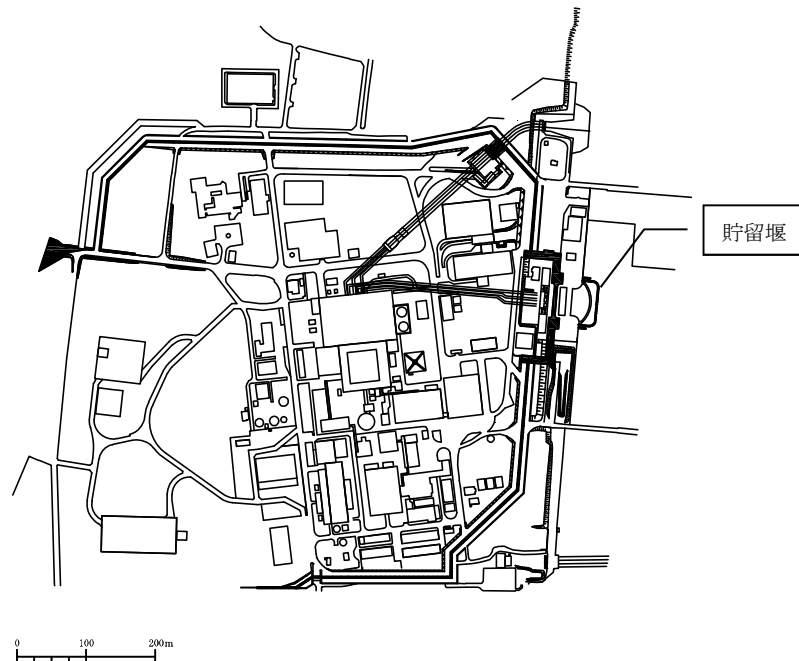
(1) 貯留堰 平面配置図 (全体図)
